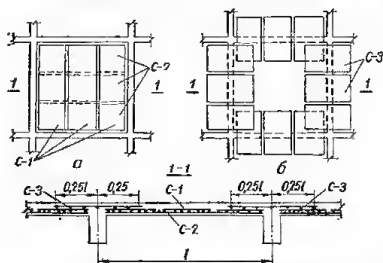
Армирование плит, работающих в двух направлениях, узкими сетками с продольной рабочей арматурой:
